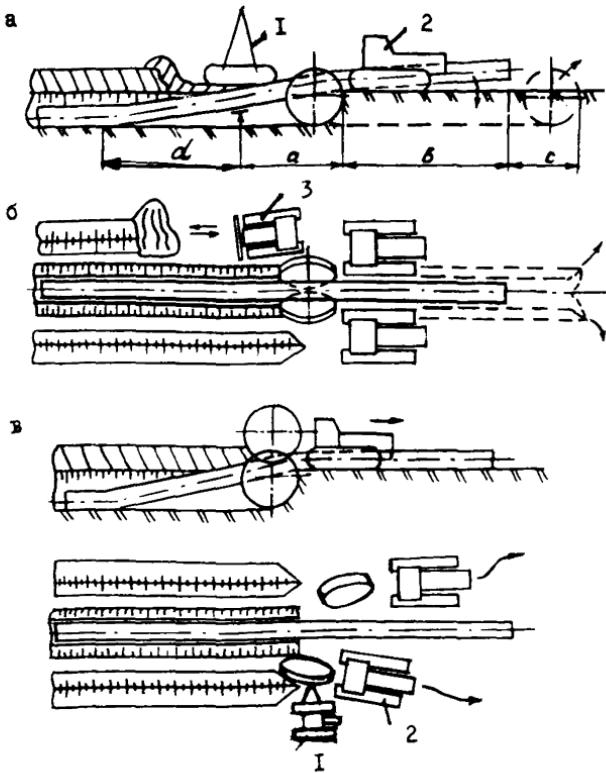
Выглубление двухроторного экскаватора-трубозаглубителя:
